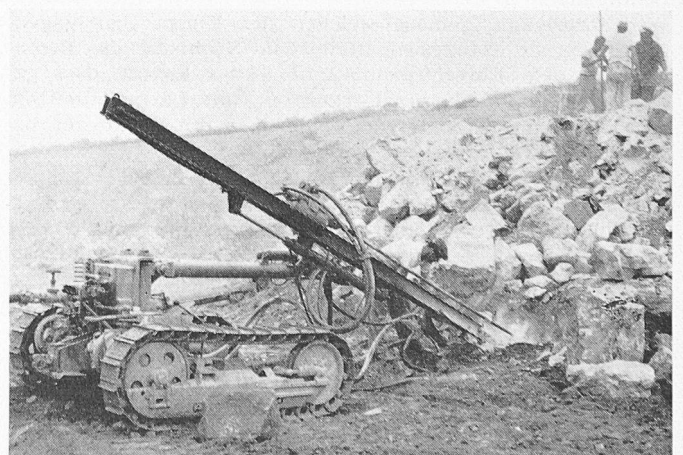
Universalbohrwagen *Ingersoll-Rand Crawl-IR
